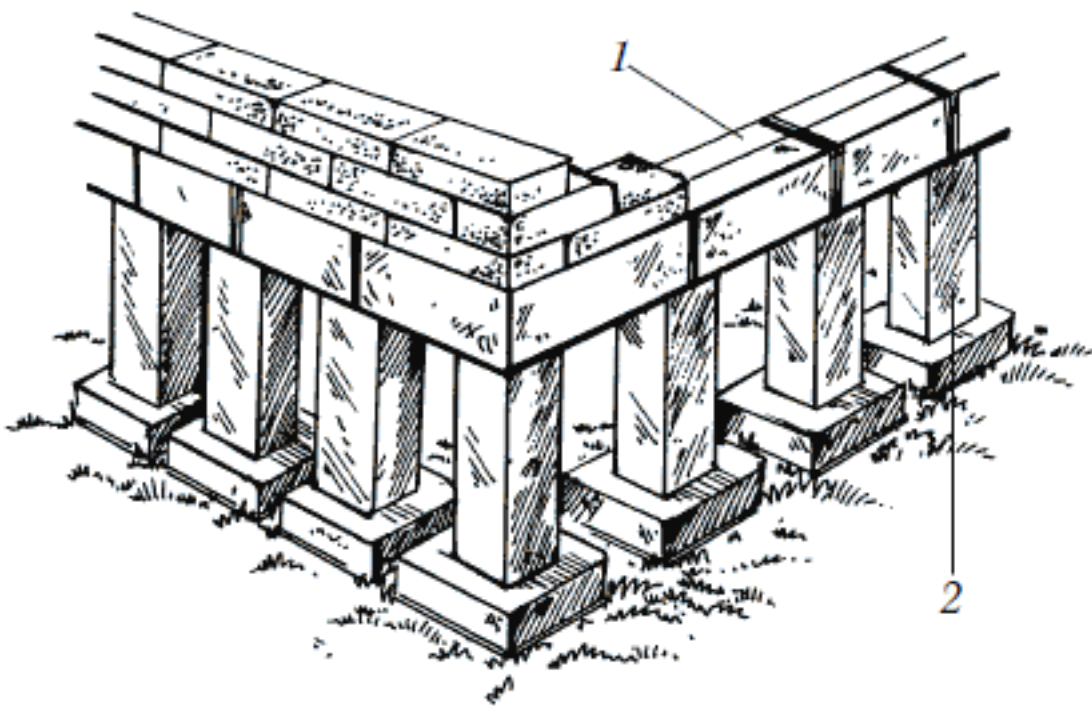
Столбчатый фундамент: 1 – обвязочная балка или ростверк (железобетонная балка), 2 – столб
